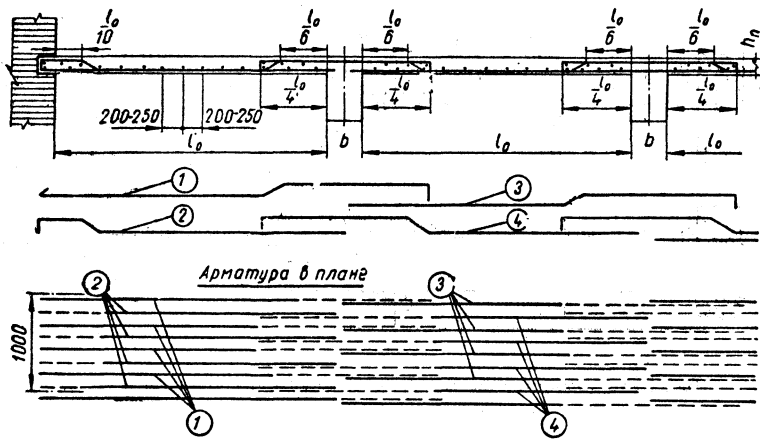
Армирование многопролетной плиты отдельными стержнями.
